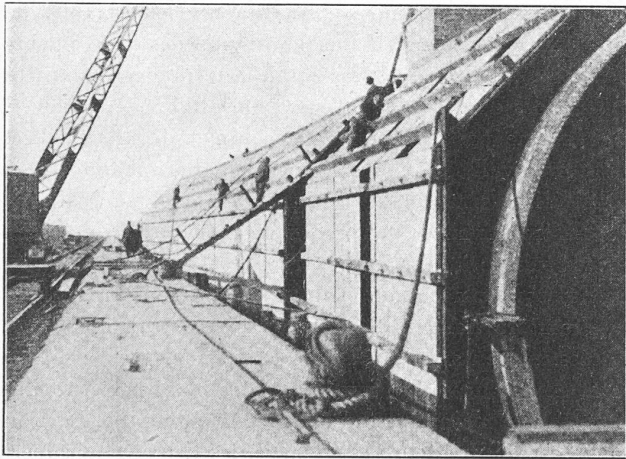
Tunnel à Déroit. — Pose des coffrages, sur tube flottant, pour le bétonnage intérieur, sous l'eau, avant le remorquage vers la tranchée. Tout en avant, une oreille de jonction.
